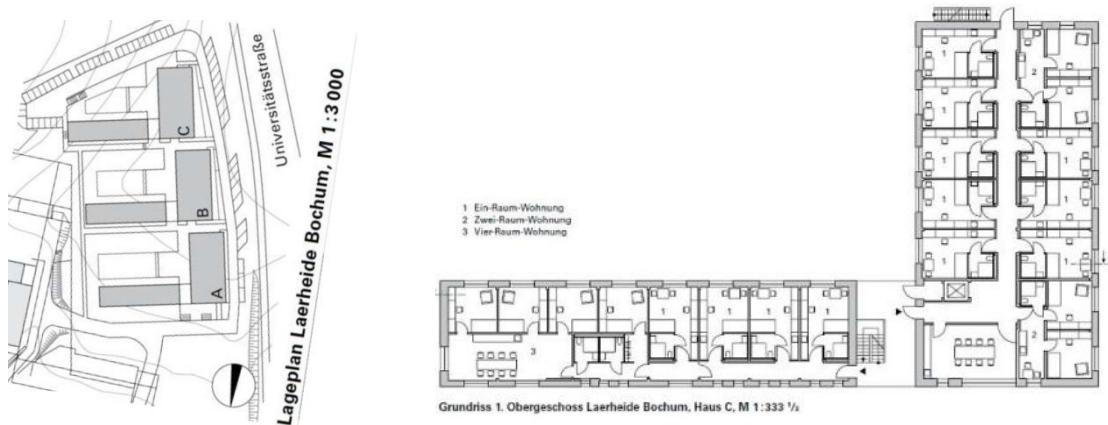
untersuchter Gebäudekomplex, Architektengrundriss Gebäude A
